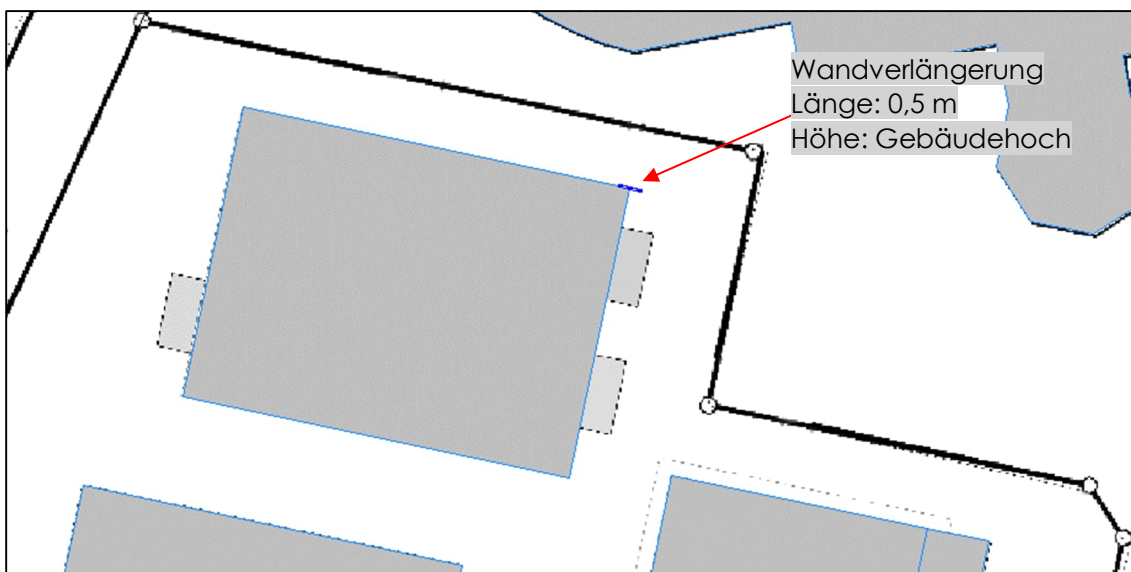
Lageplan mit Kennzeichnung der zusätzlich geplanten Wand
